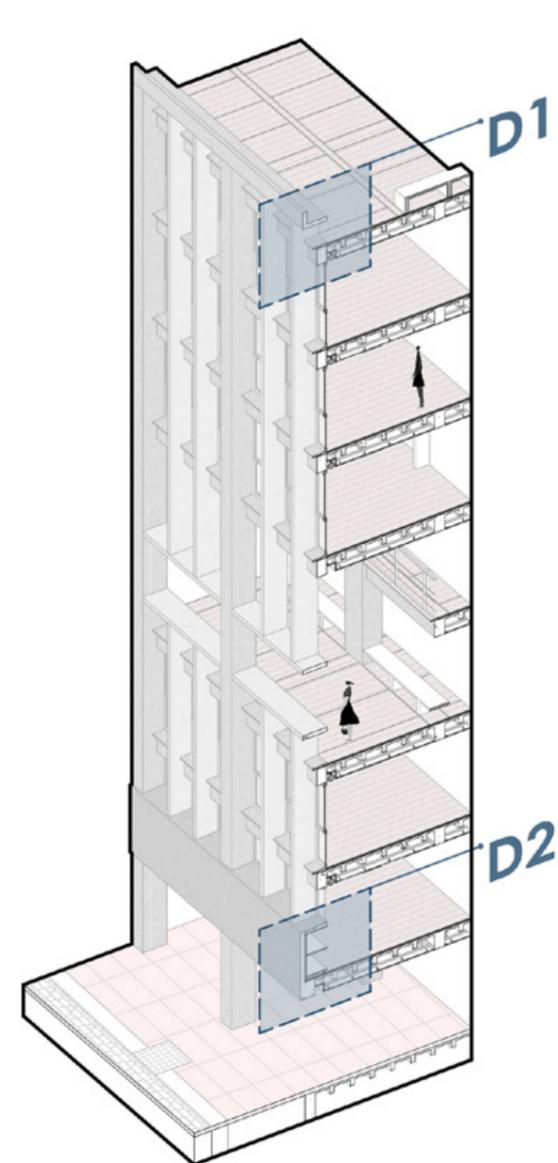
Axonometría de sección constructiva 1. Fuente: Elaboración propia.
